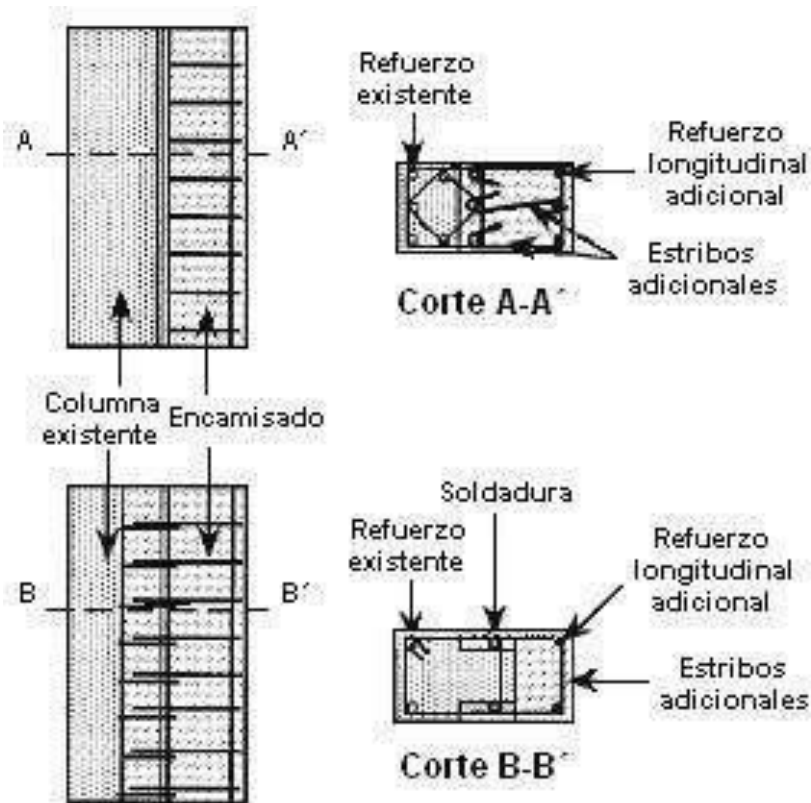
Encamisado de columnas realizadas en una dirección. Fuente: Retrofitting Design of Building Structures, Xilin Lu (2010).
